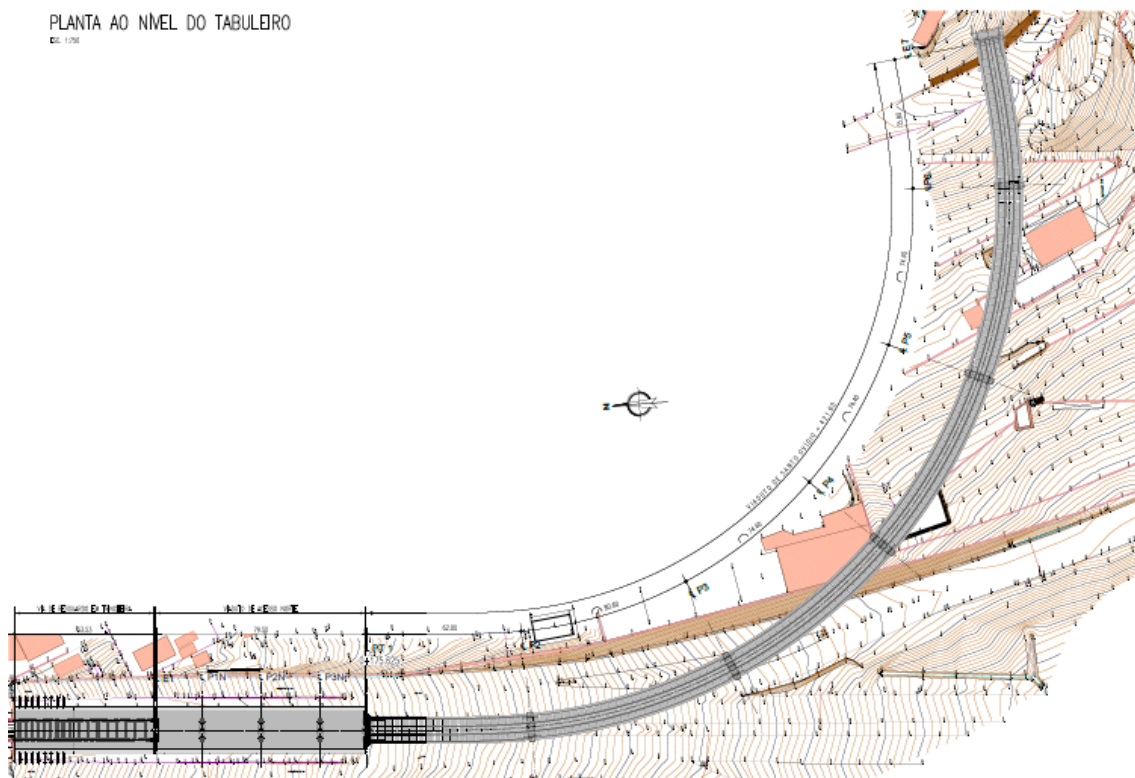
Planta ao nível do tabuleiro Projeto Viaduto Santo Ovídio
